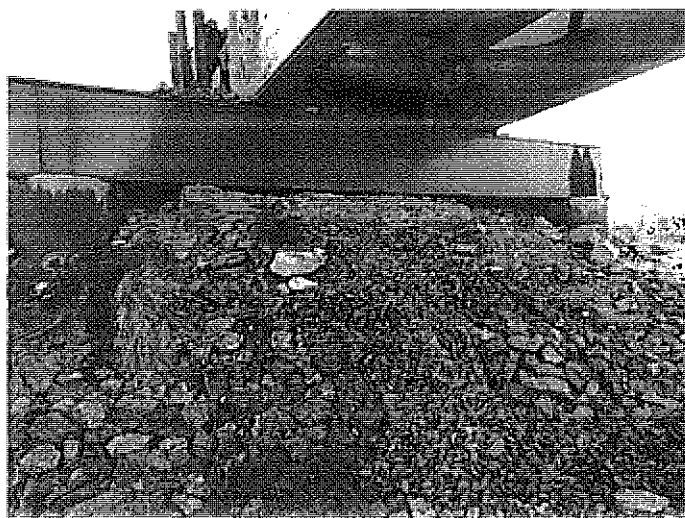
Rigidizador de la viga dintel "lado Rosario" doblado (vista desde terraplén).
